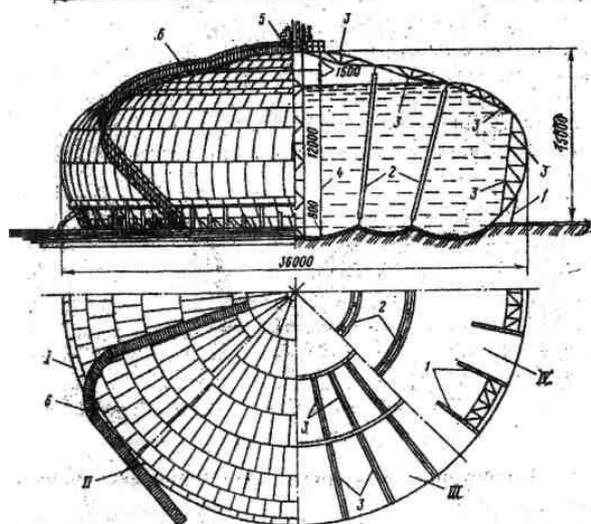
Каплевидный резервуар с одним торкуполом:
